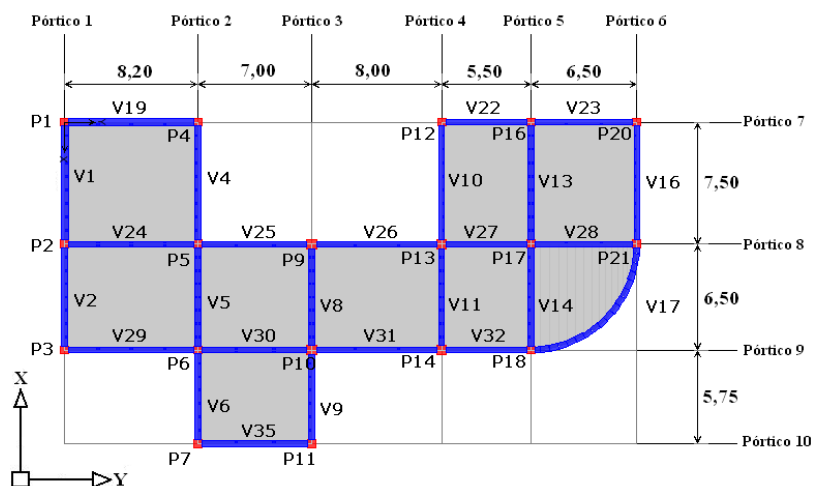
Vista em planta do modelo original com os elementos numerados. Unidades em m.
